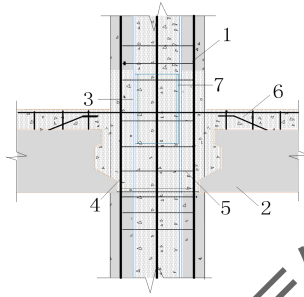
叠合柱与预制钢筋混凝土梁连接
